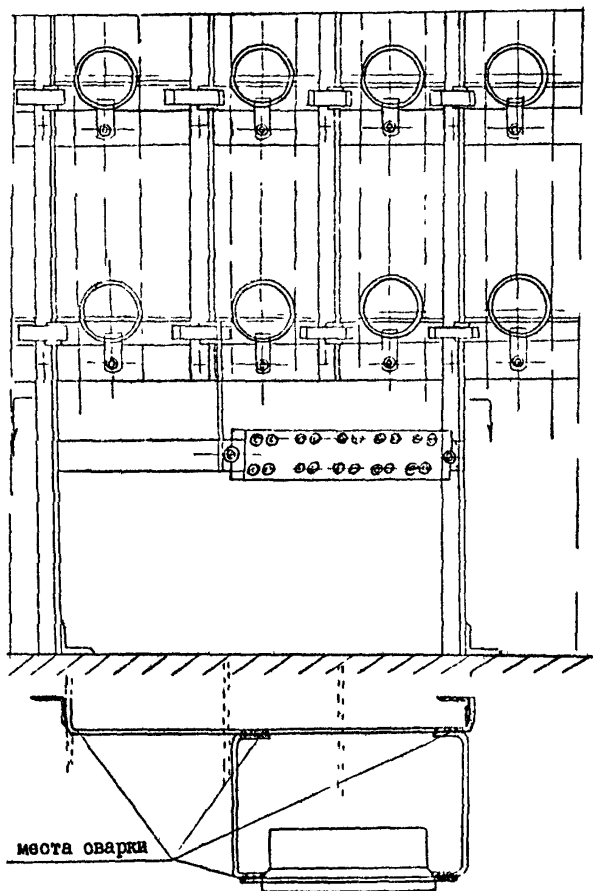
Крепление рамки с испытательными гнездами в асбестовом кроссе
